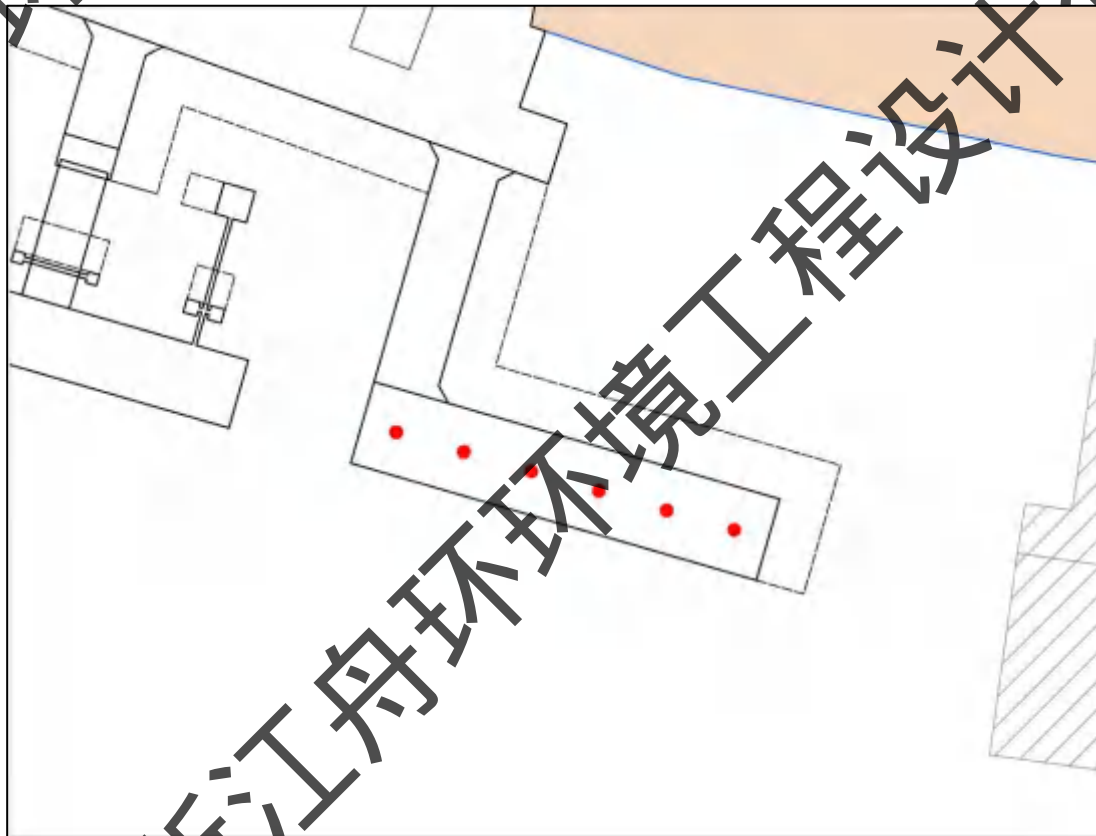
PHC 桩施工悬浮泥沙源强点布置示意图
